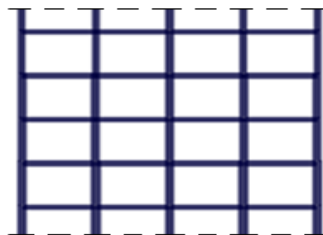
Schéma d'un portique (poteaux et poutres).
